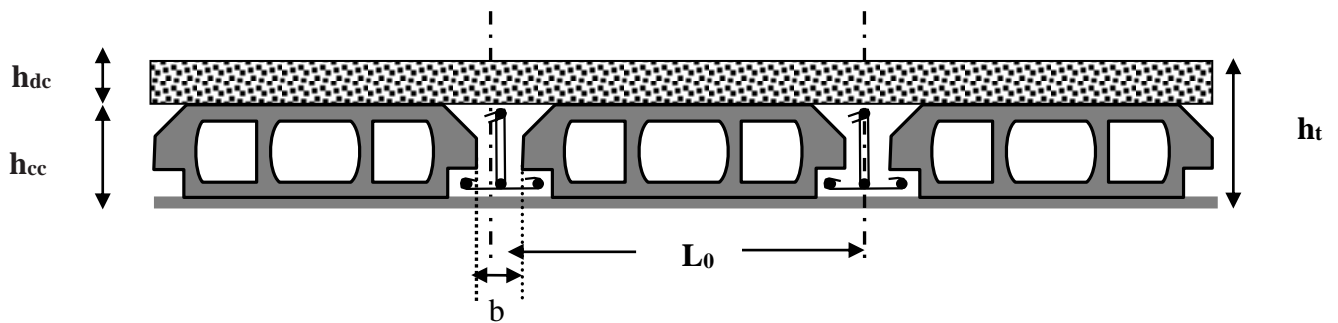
Coupe transversale sur un plancher à corps creux.
